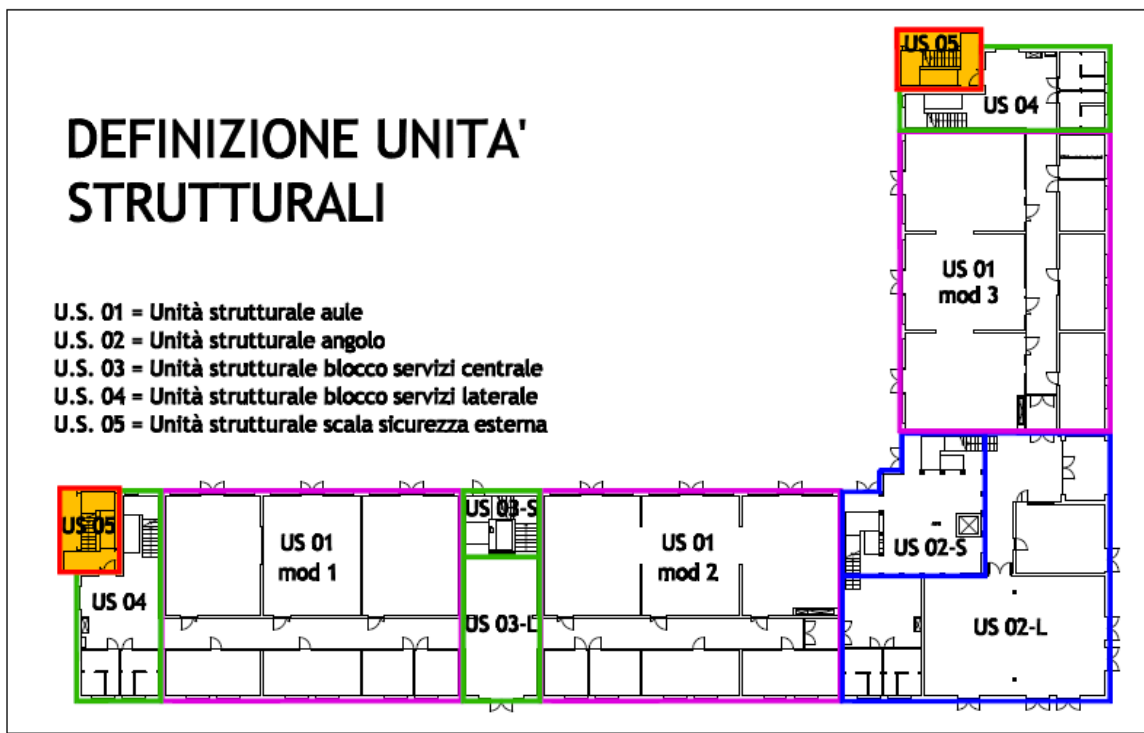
Planimetria generale Polo dinamico con individuazione delle Unità strutturali 05
